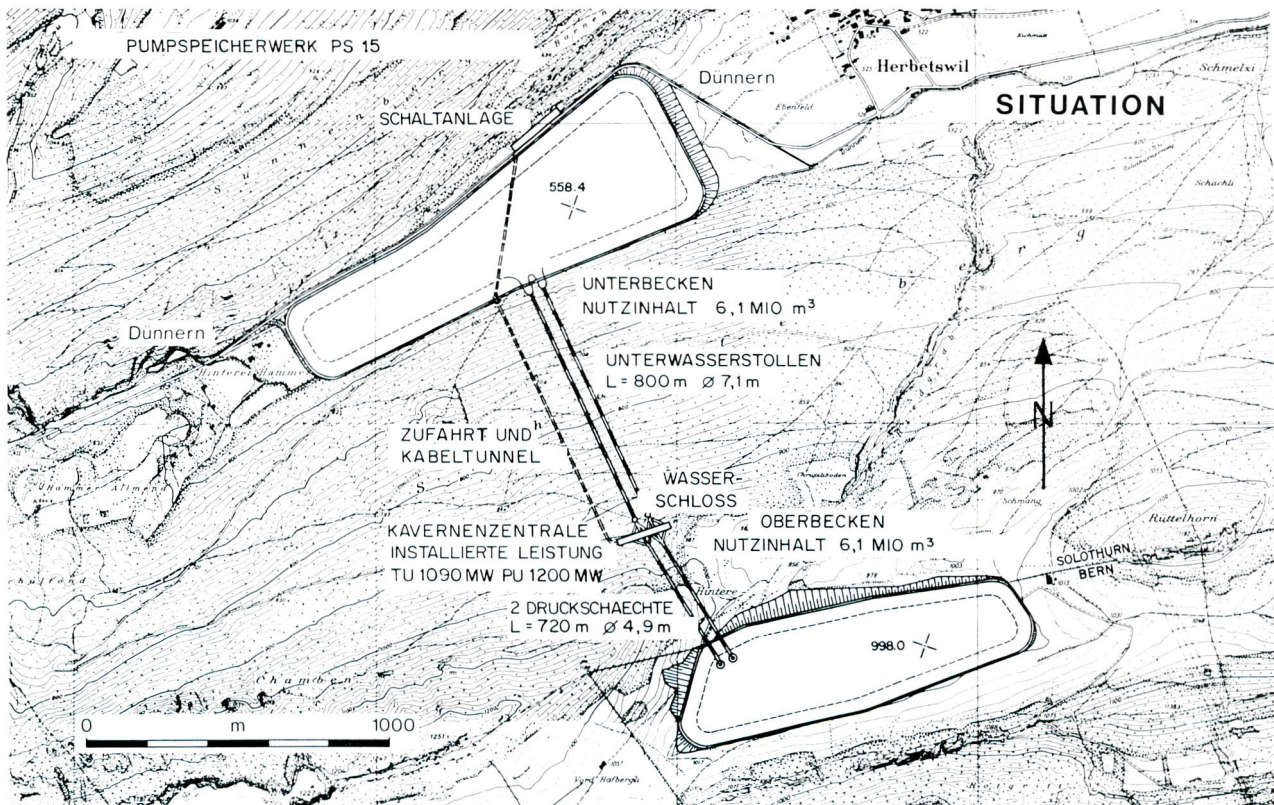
Lageplan des Pumpspeicherwerks Herbetswil
